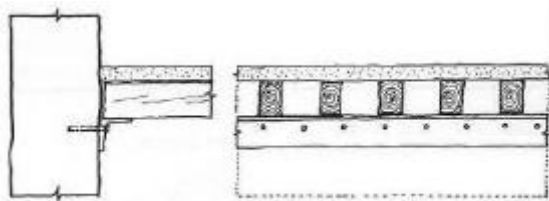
Cantoneira metálica servindo de apoio ao vigamento (Arriaga;2002).
